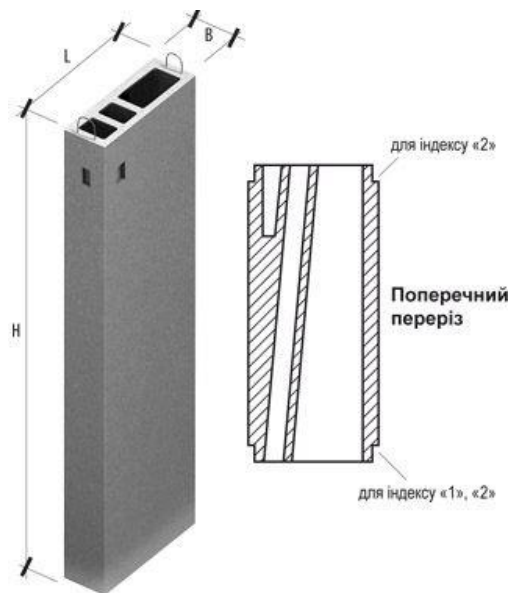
Розріз та вигляд вентиляційних блоків із залізобетону
